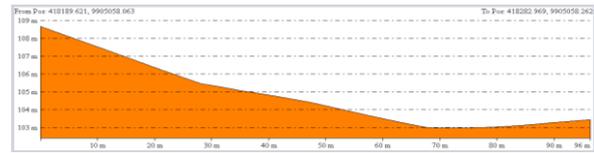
Penampang Kemiringan Jalan Tambang Pit 3E Segmen 2-4
